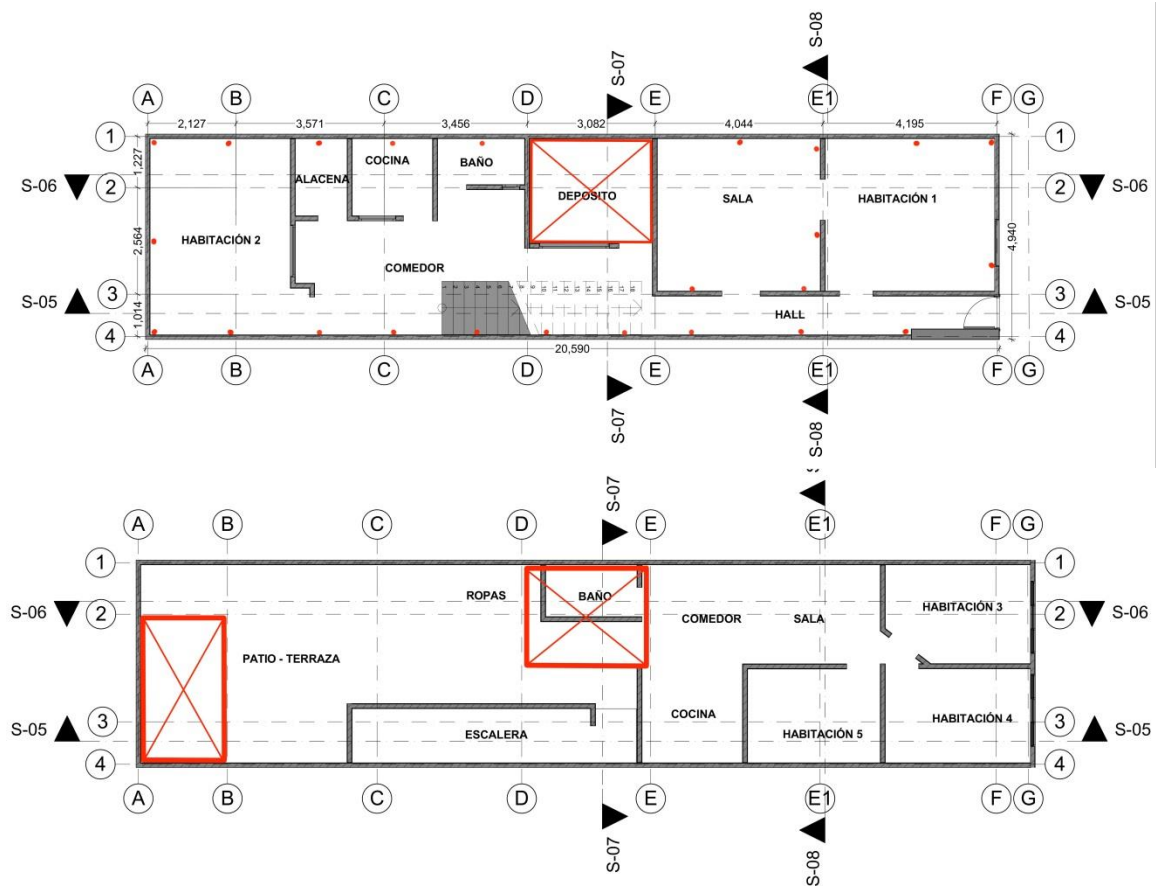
Planta de primer nivel de existente y propuesta, evidenciando la localización de los nuevos vacíos y localización de sondeos. Elaboración propia 2017.
